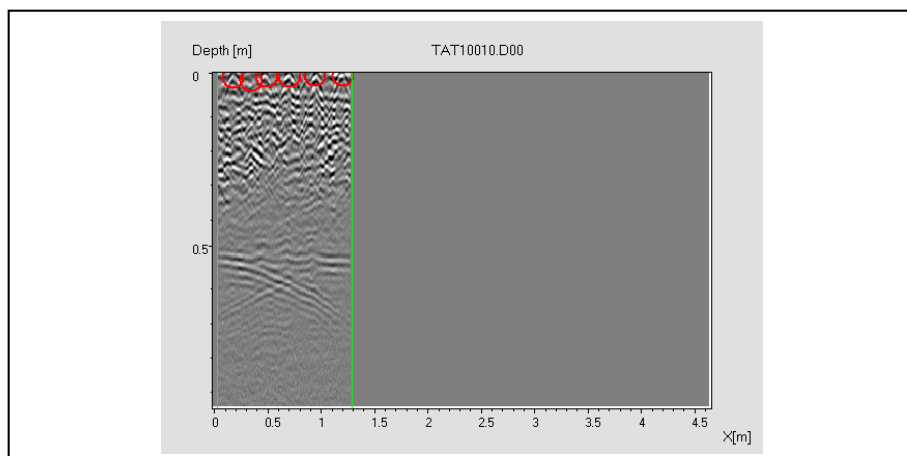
SEZIONE TRASVERSALE PORZIONE A (VERTICALE) TAT10010
